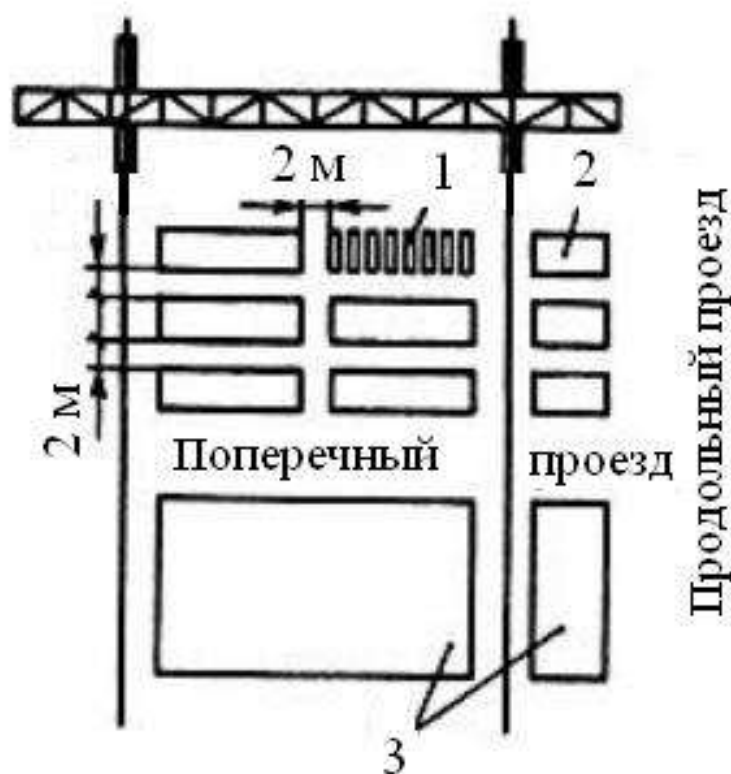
Планировка группы штабелей, укладываемых козловым краном:
